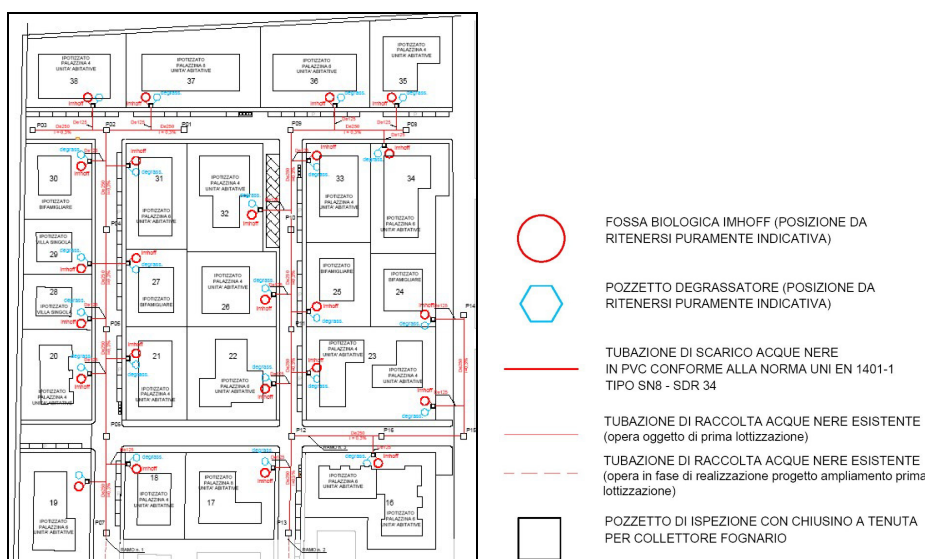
Progetto del piano attuativo (comparto est): planimetria della rete fognaria
